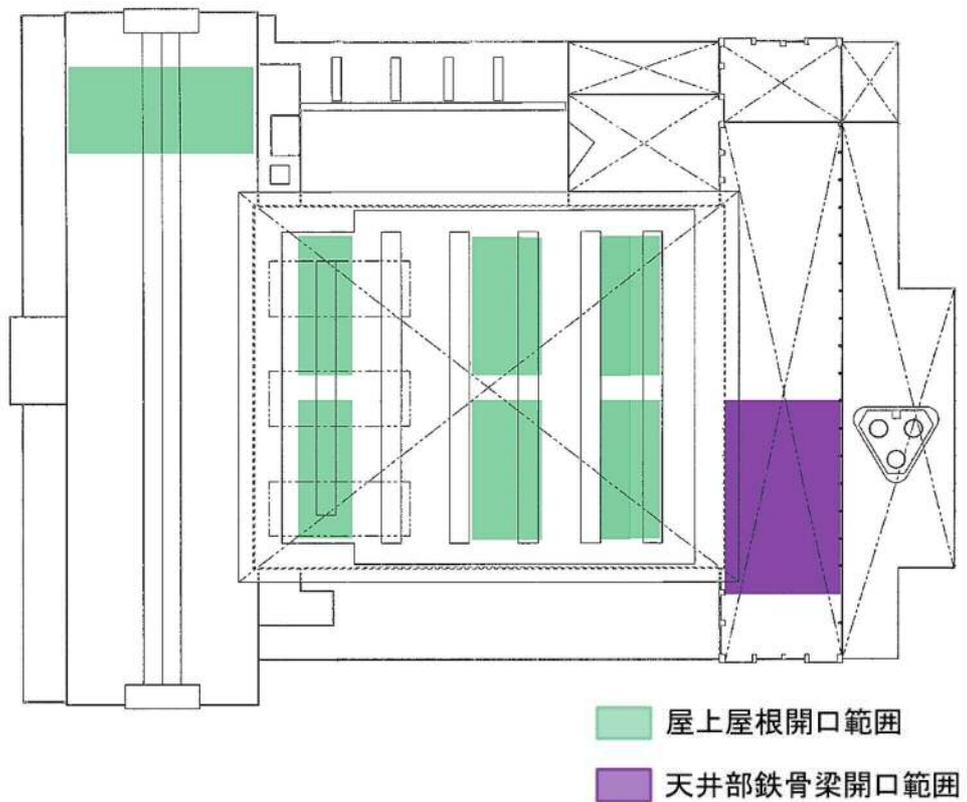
屋上屋根等の開口範囲（屋根階平面図）
